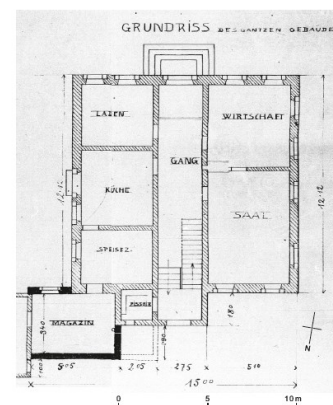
Grundriss Erdgeschoss, 1:200.
